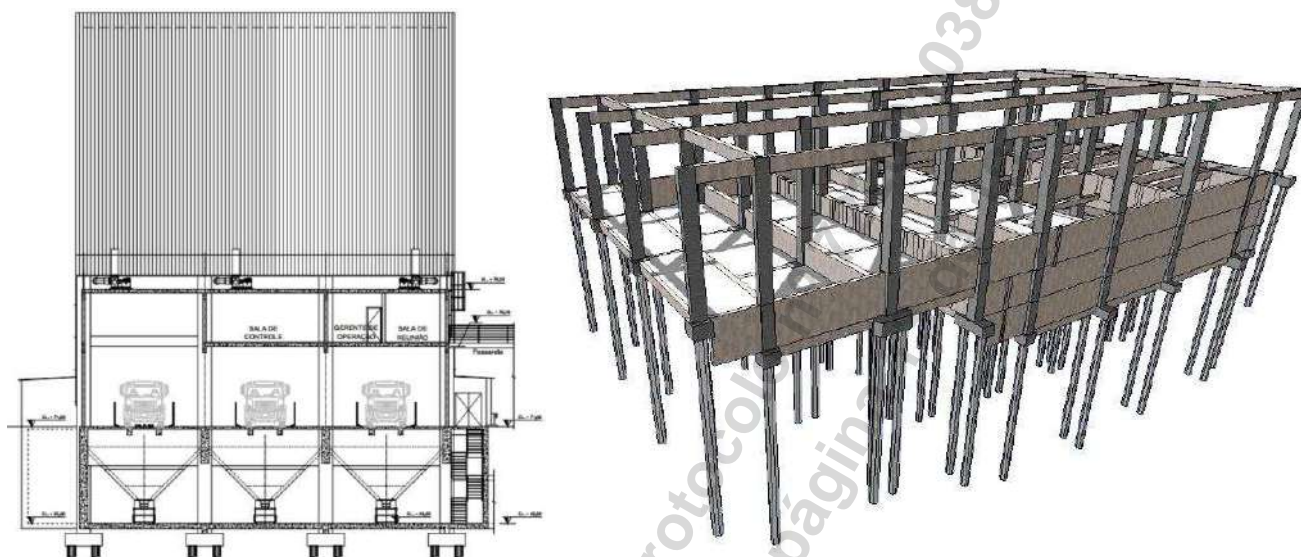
Seção transversal do tombador a esquerda e imagem 3D das estruturas em concreto armado dos tombadores.
